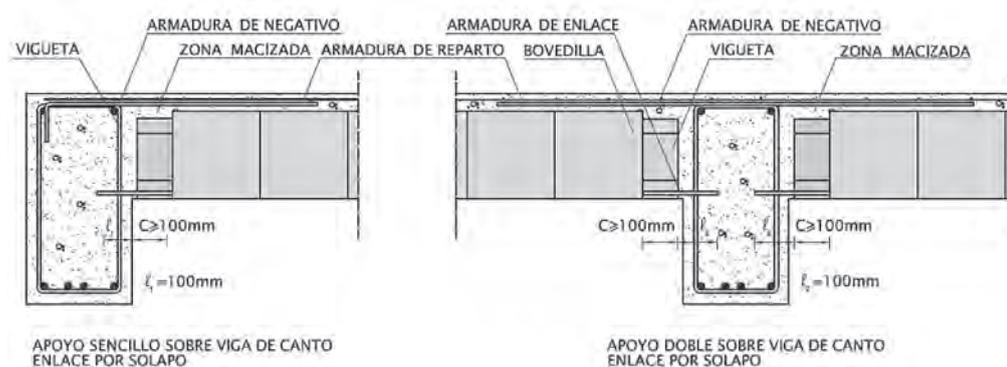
apoyo sobre viga de canto. Enlace por solapo.
